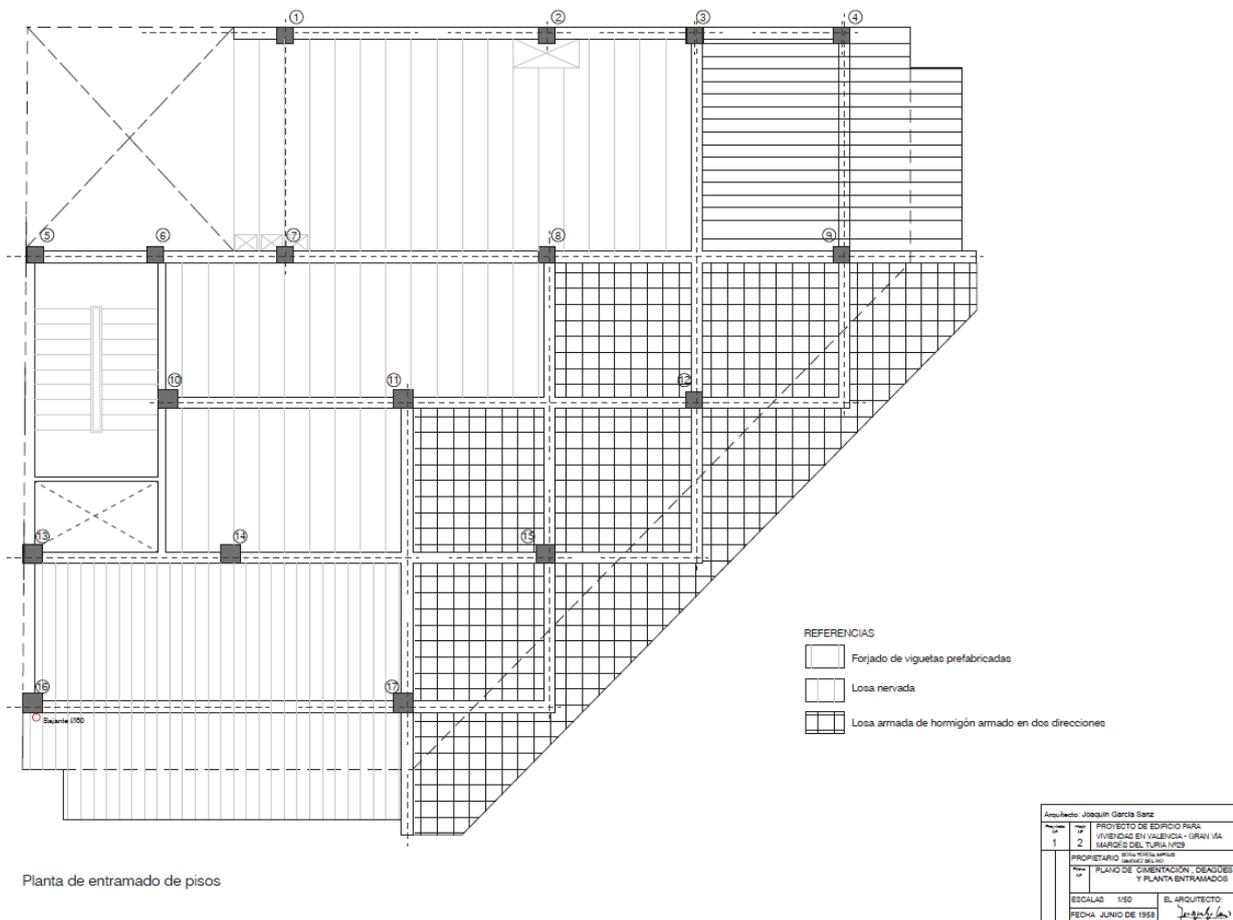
Plano de entramado de pisos. Elaboración propia.
